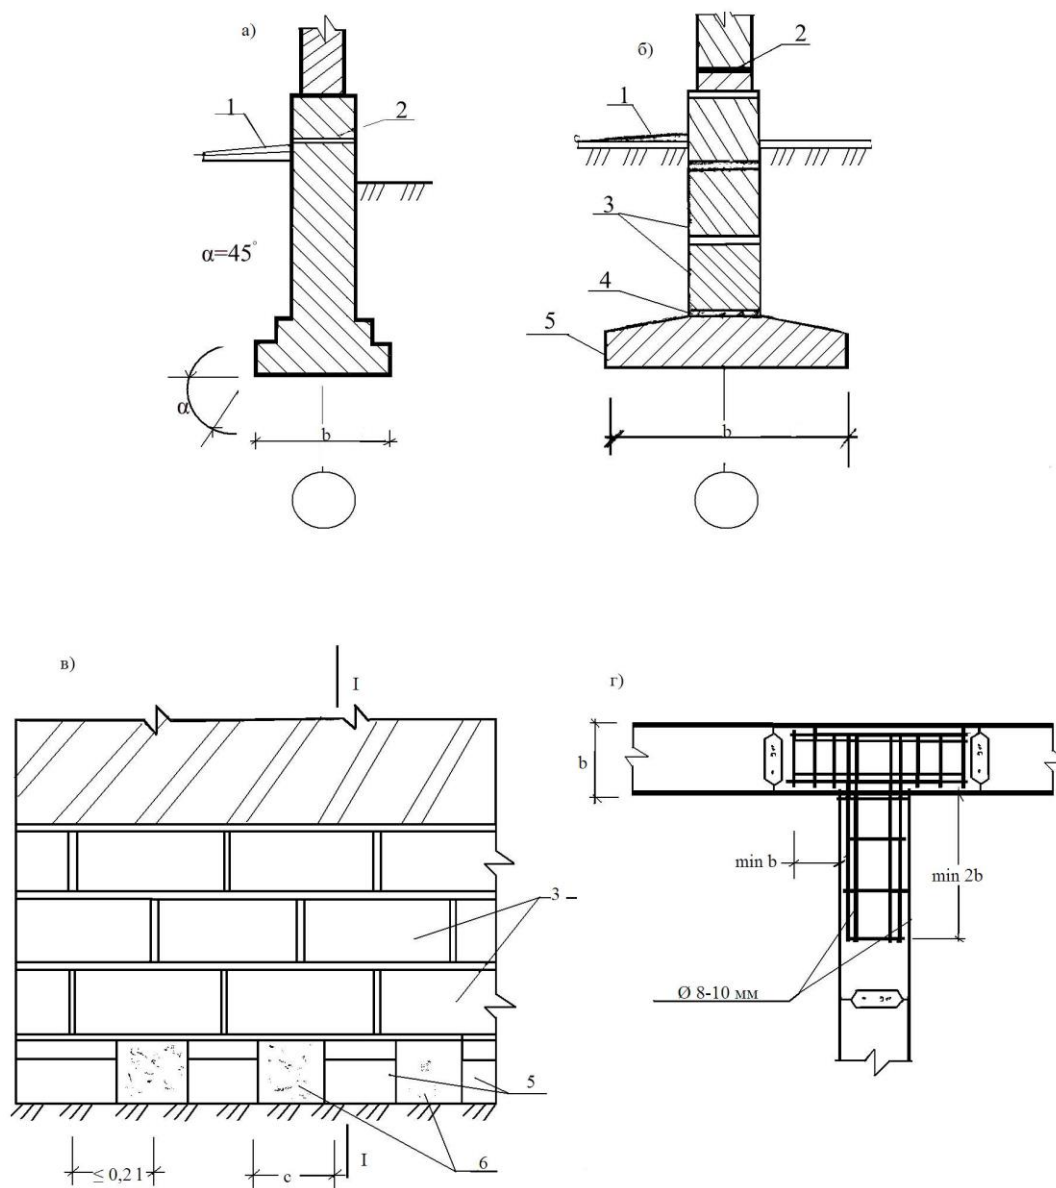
Схеми конструкцій стрічкових фундаментів:
